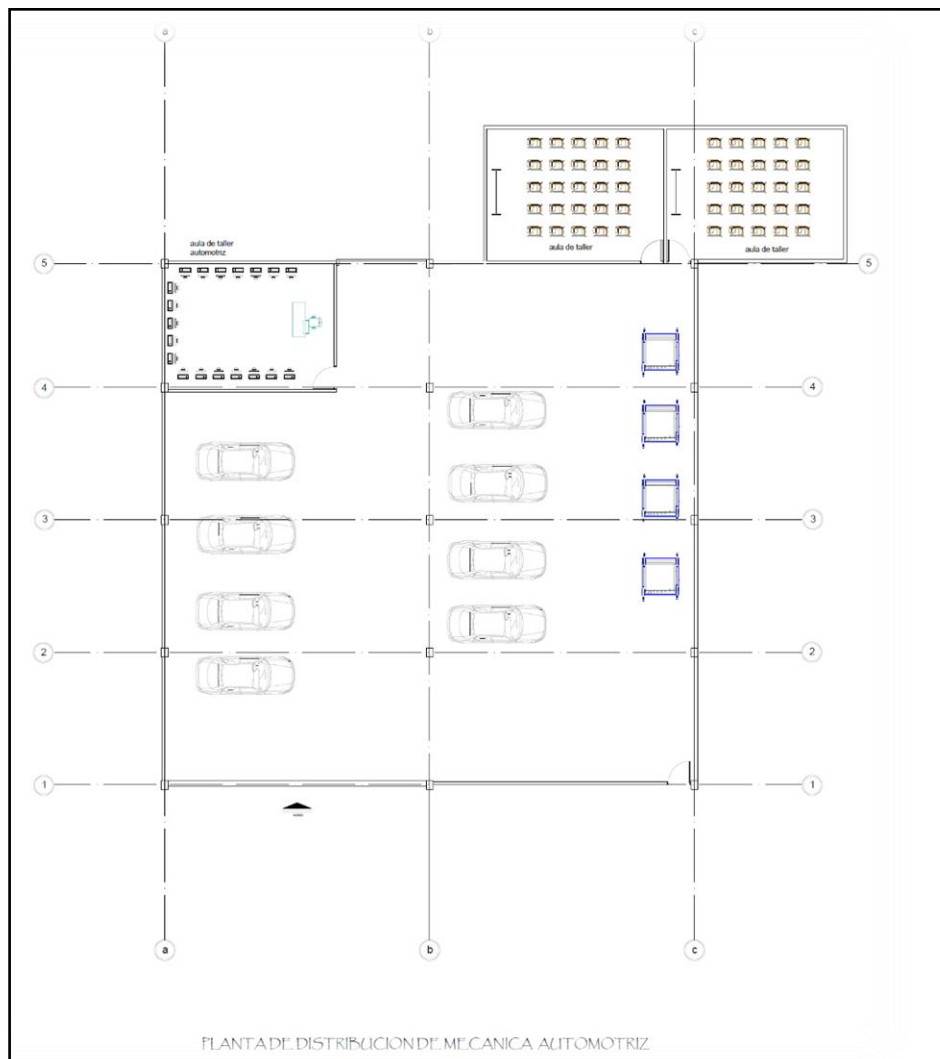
Plano Levantamiento planta física del taller de Mecánica Automotriz
